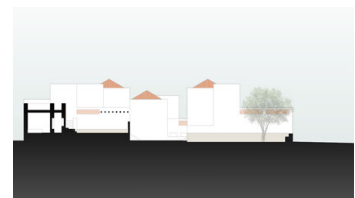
Planta e corte pátios dos quarteirões abertos à paisagem 1:1000
